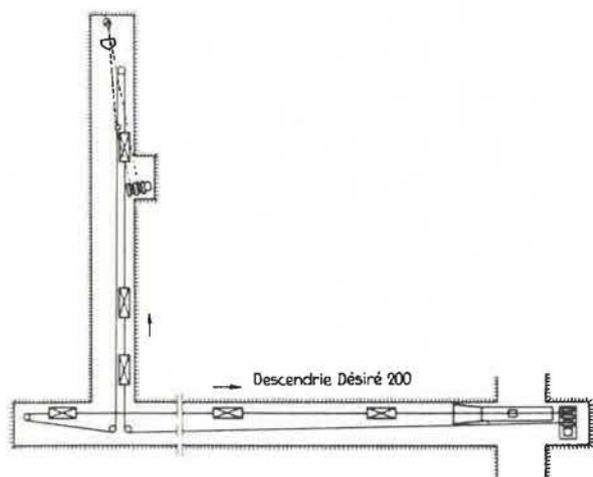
Desserte d'une descenderie et d'une voie transversale en creusement par une même installation de scrapage.
